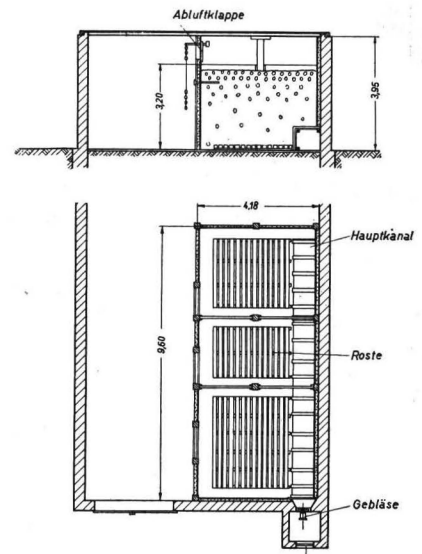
Grundriß und Querschnitt eines Gemüse-Lagerhauses
